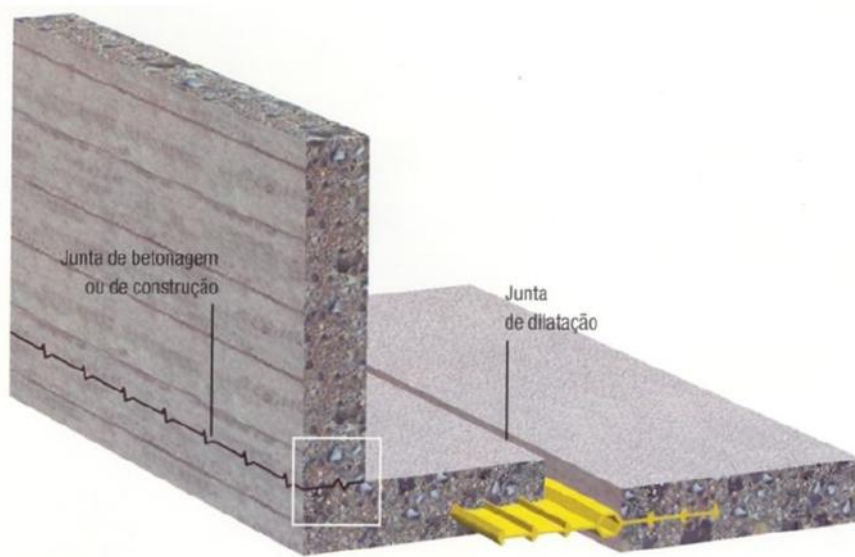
Juntas de betonagem e dilatação (Pereira, 2010).
